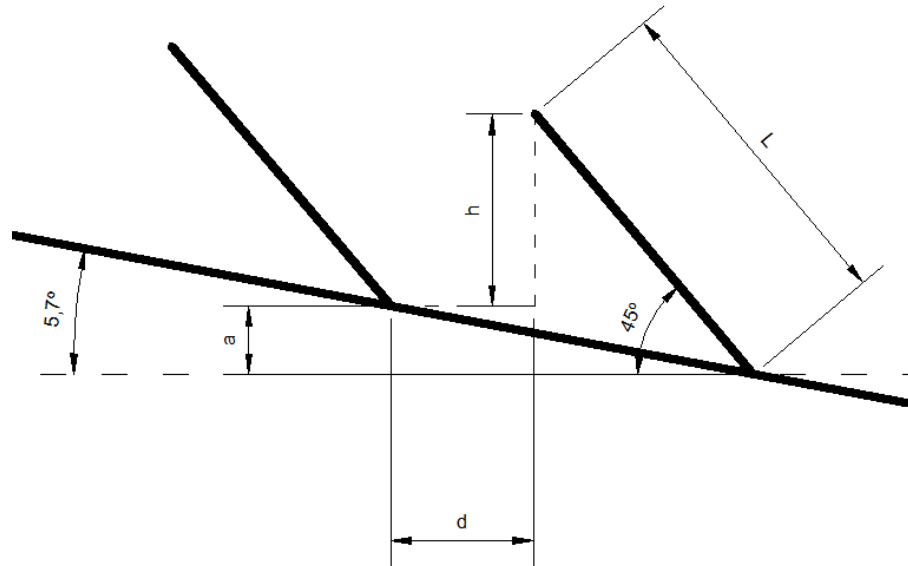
Esquema para el cálculo de la separación zona calefacción
